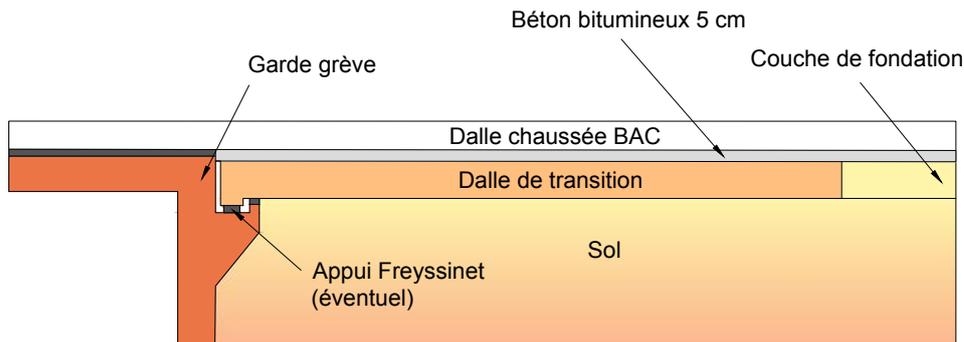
Exemple de franchissement d'un passage inférieur de faible ouverture par une chaussée en béton armé continu
